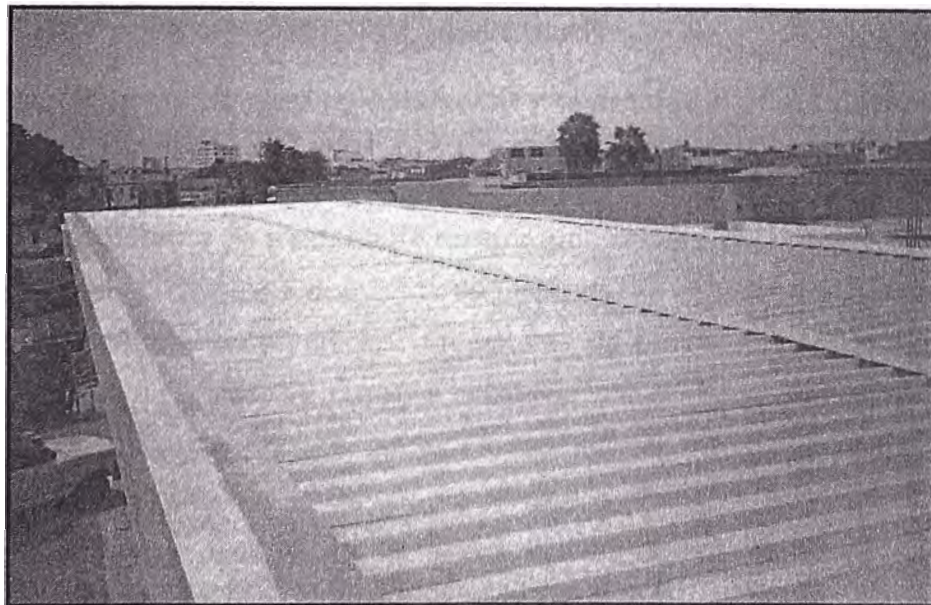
El forrado de la estructura es pintado y el techo se colocó una cobertura metálica
